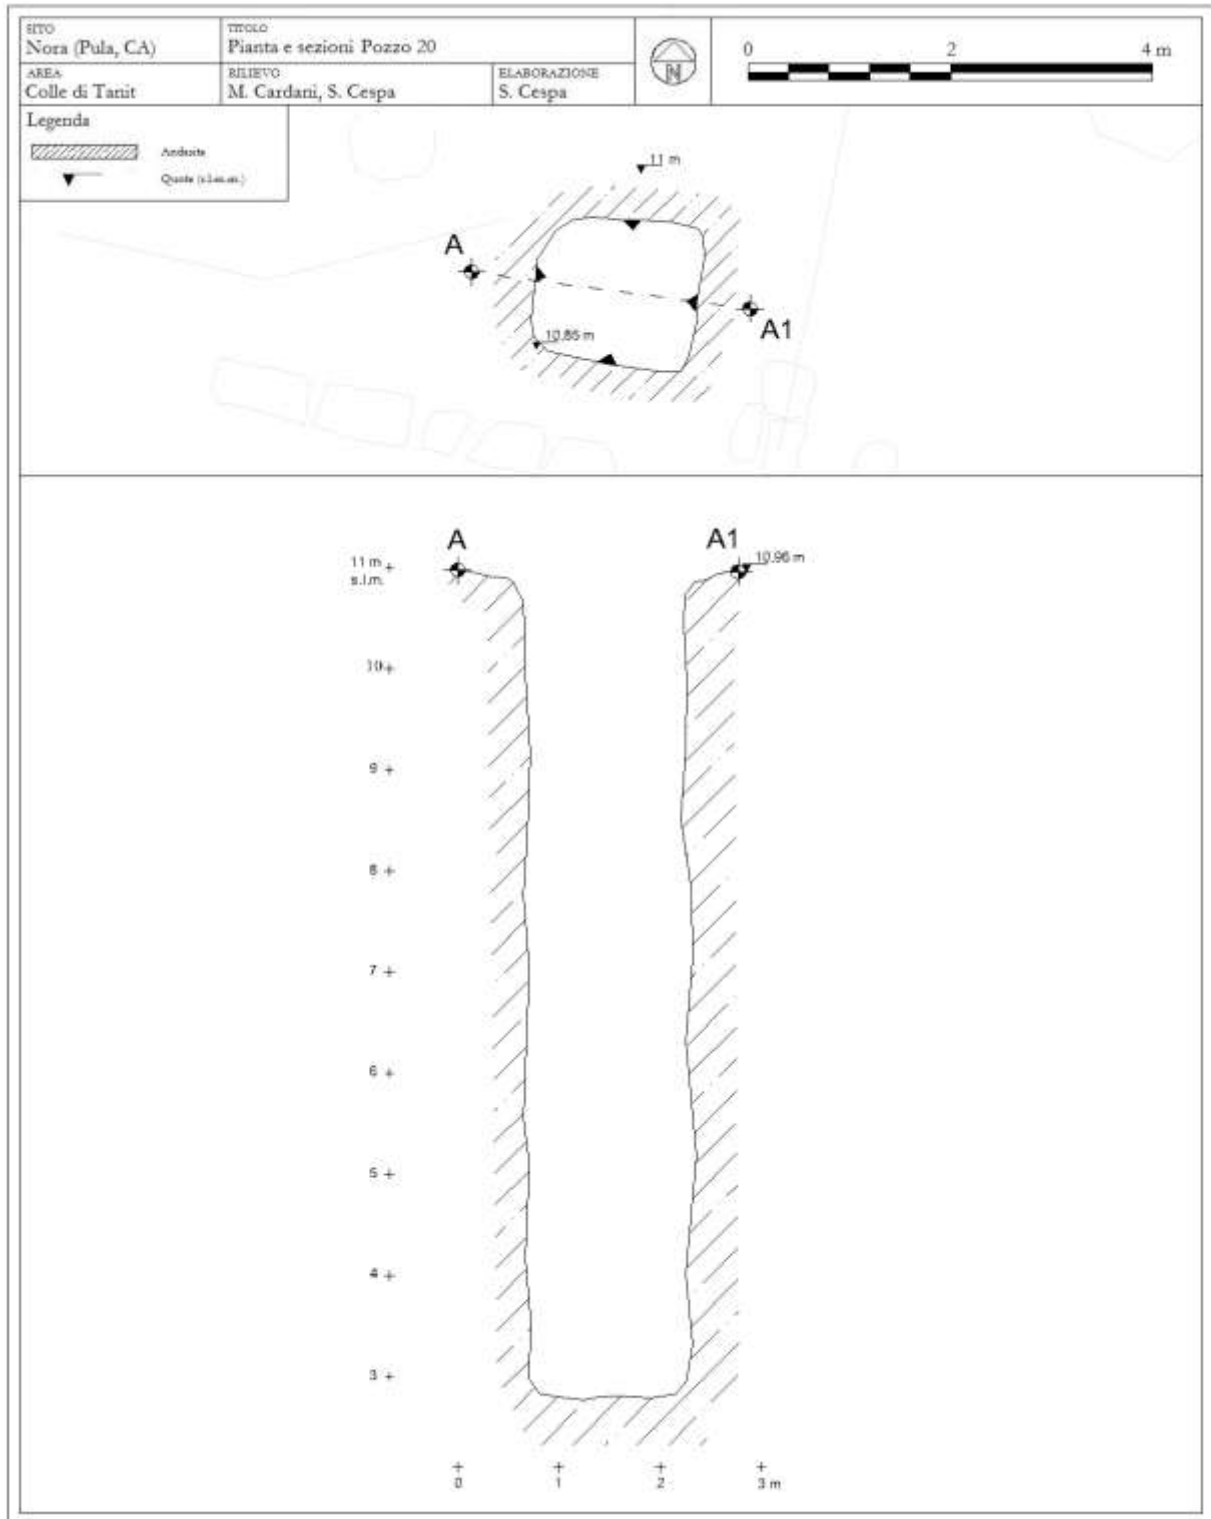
Pianta e sezione del pozzo 20 (elaborazione dell'autore).
